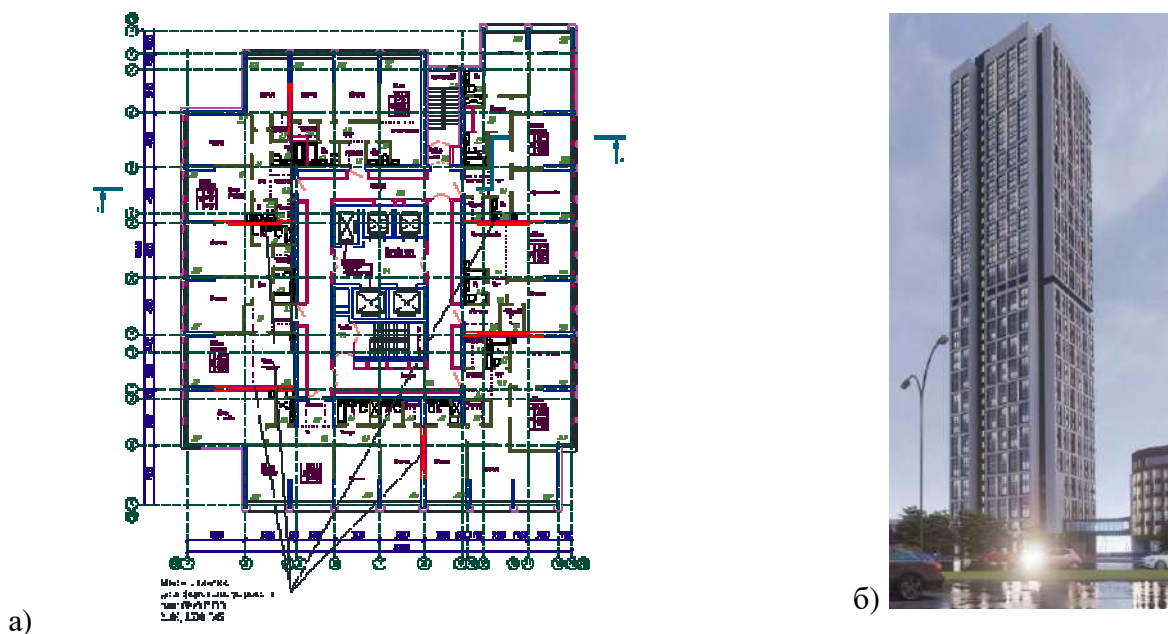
43-х этажный жилой дом: а) план типового этажа; б) визуализация здания
